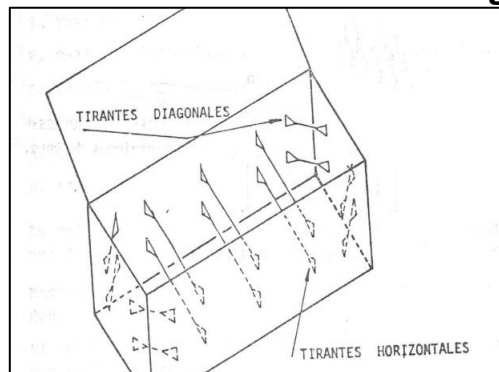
Entibado y llenado de la unidad de gavión, Ricaurte
